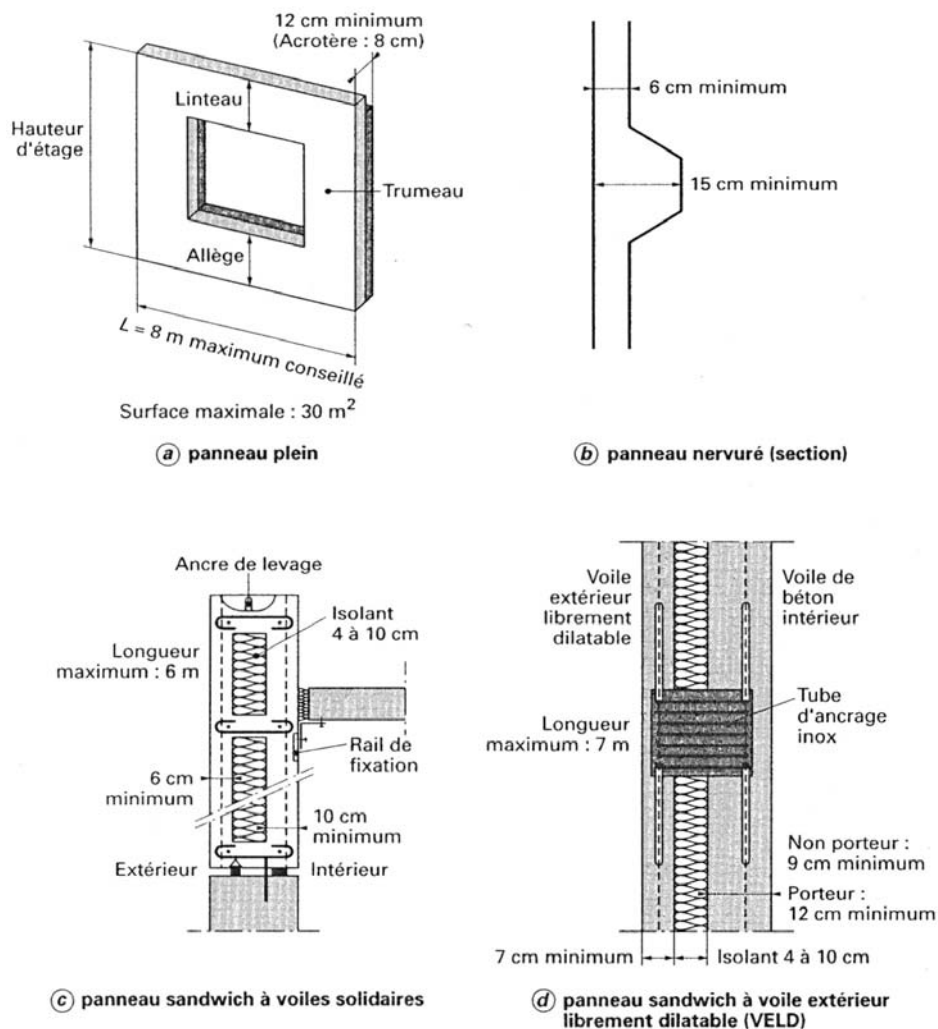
Les quatre types de panneaux de façades en béton armé préfabriqués [CERIB].
